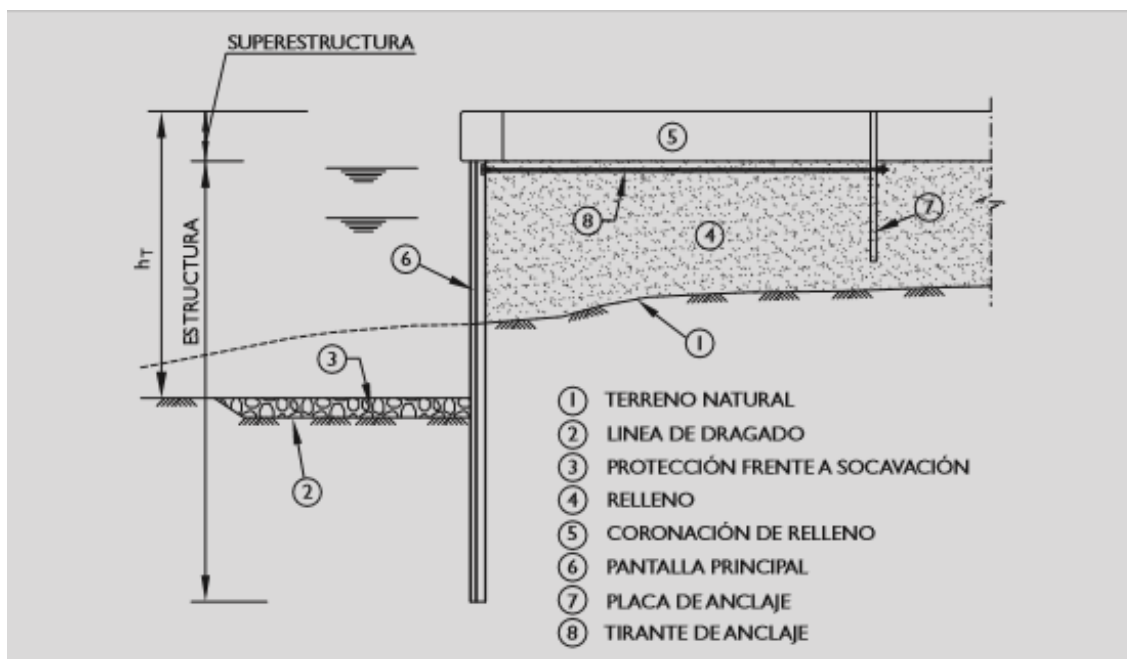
Obra de atraque de pantallas sin plataforma superior de descarga, sección tipo
